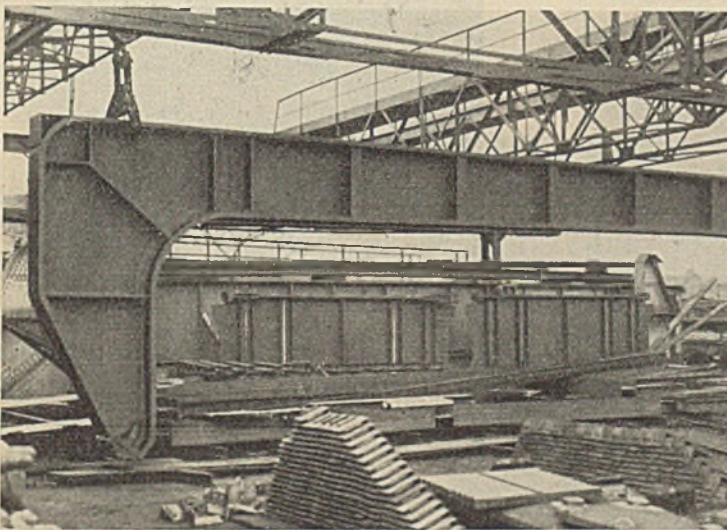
Neuer, geschweißter Rahmen für den Personentunnel im Bahnhof Duisburg (auf dem Werkhof).
